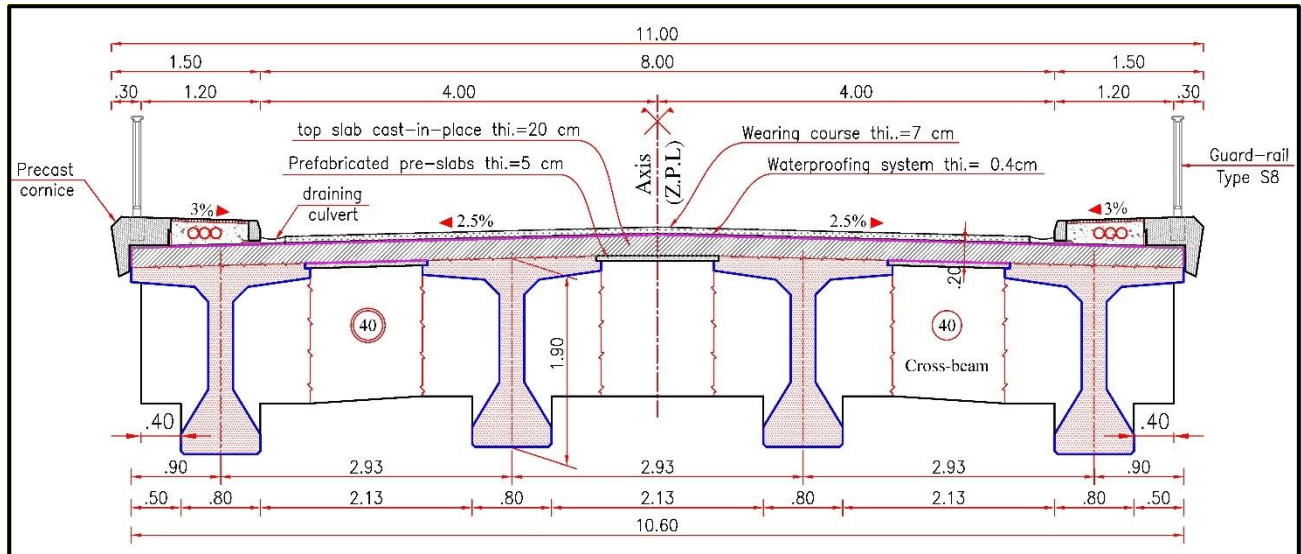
Secção transversal do tabuleiro da ponte de vigas de betão pré-esforçado (Lemba)
